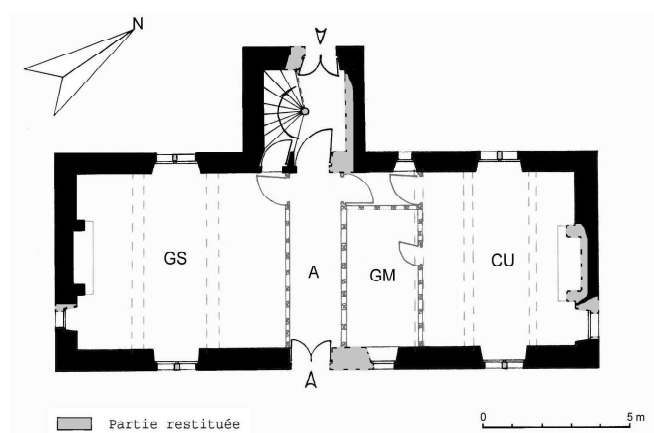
Les Mottes. Plan restitué du rez-de-chaussée entre 1554 et 1562.
